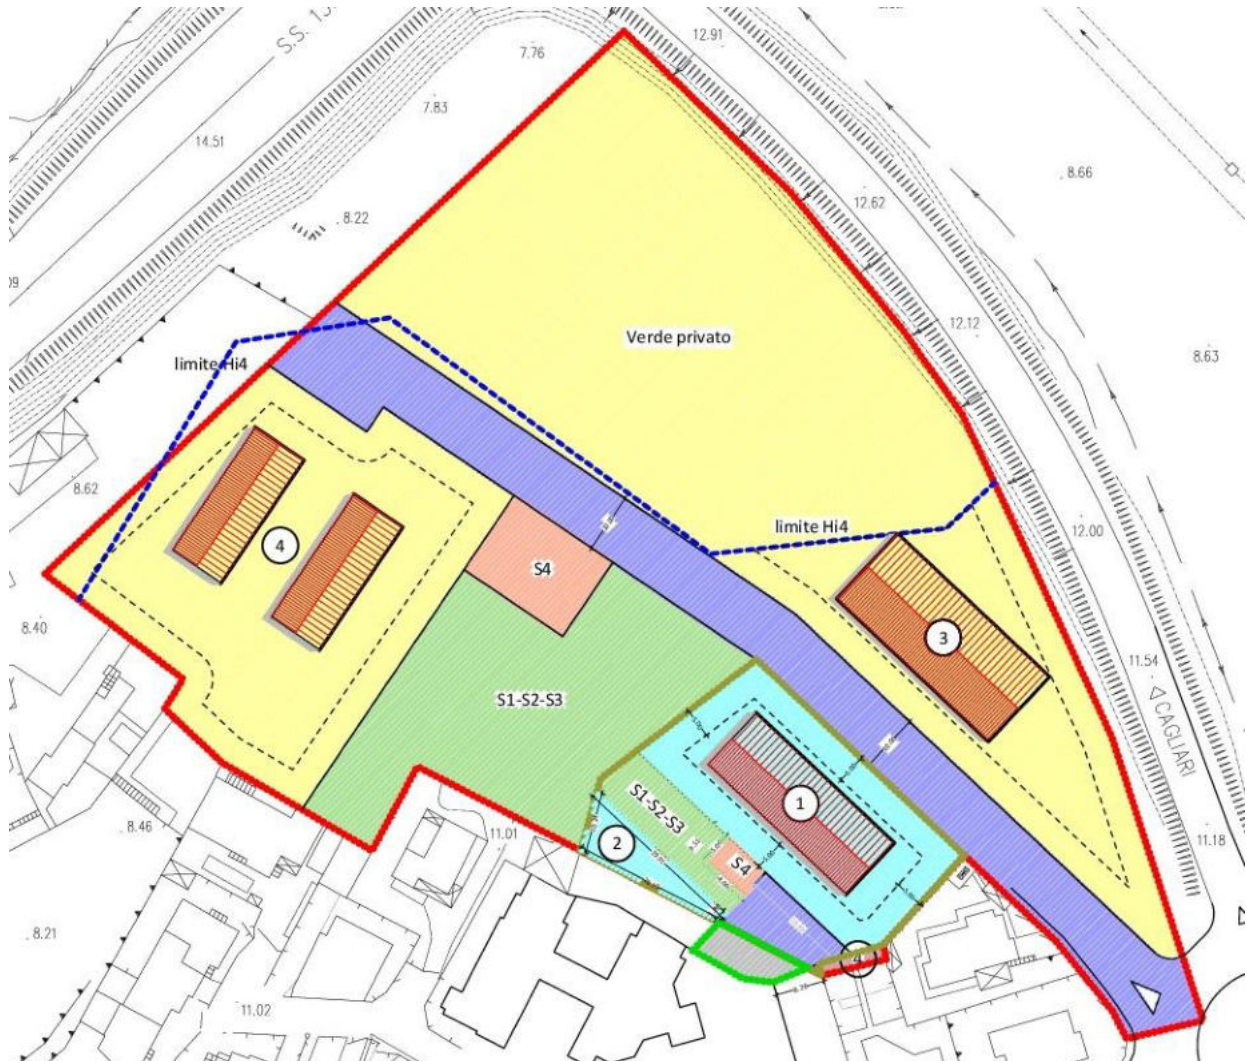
planimetria del comparto oggetto di pianificazione - destinazione in progetto delle superfici
